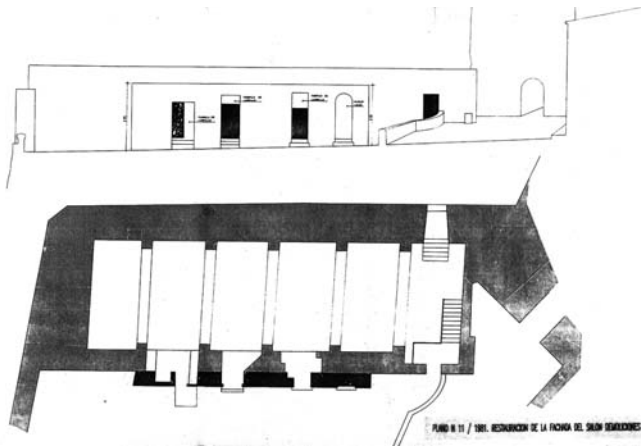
1981. Planta y Alzado del Salón. Esatado Actual. Silla
